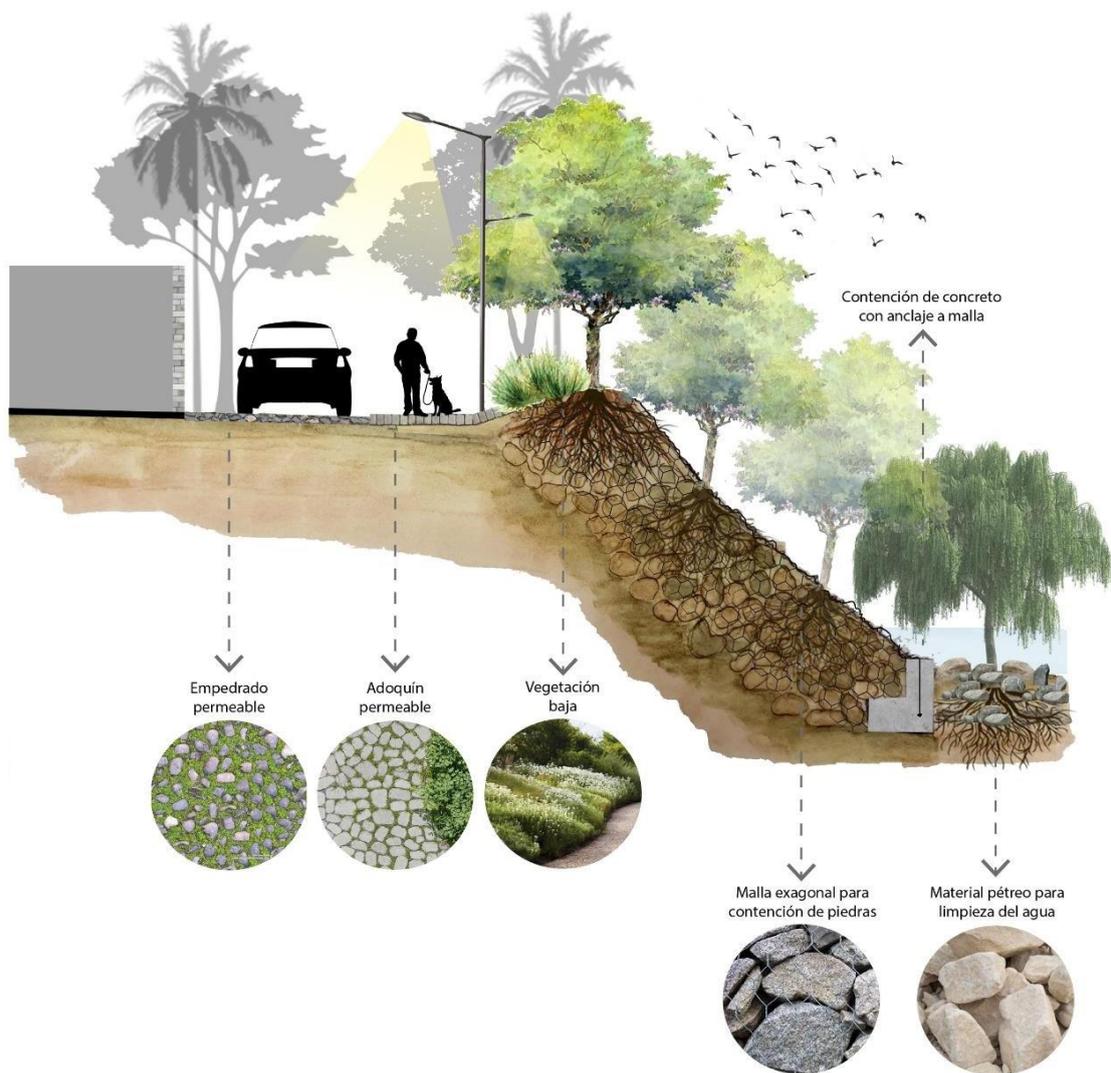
Propuesta sección detalle 2 - Tramo 2
